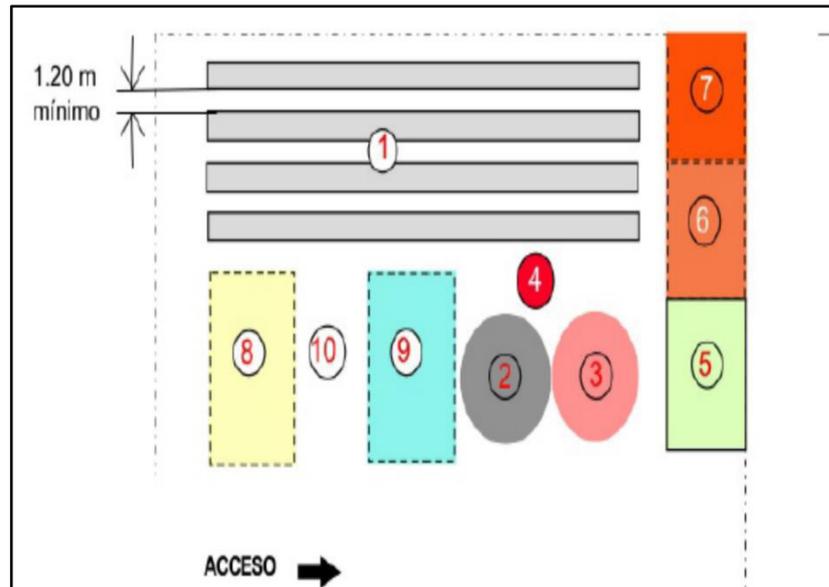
Arreglo General de una planta de viguetas prefabricadas.
